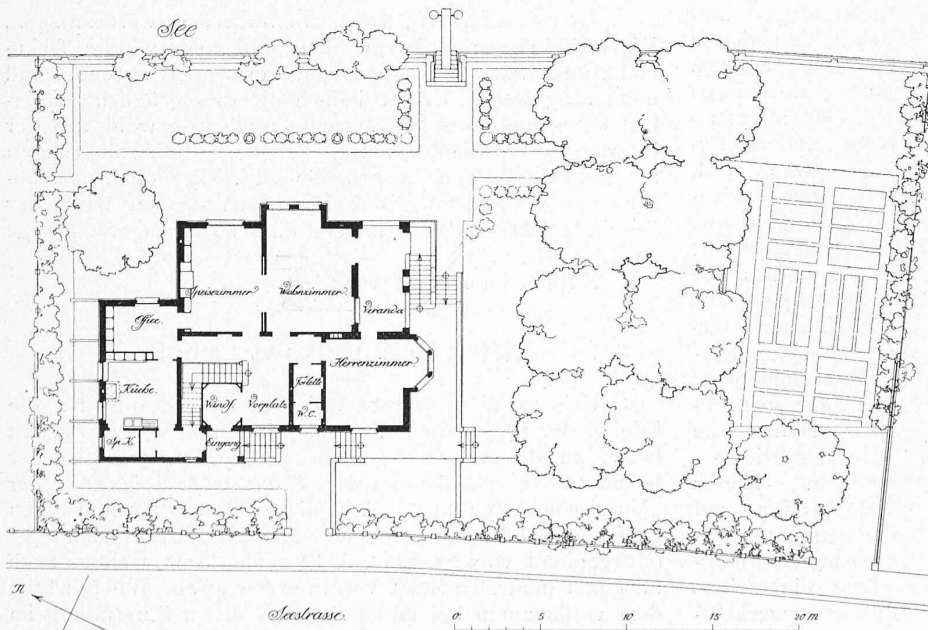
bis 3. Villa in Wollishofen. — Arch. Niedermann & Staehli, Zürich. — Lageplan mit Grundrissen. — 1 : 400.
